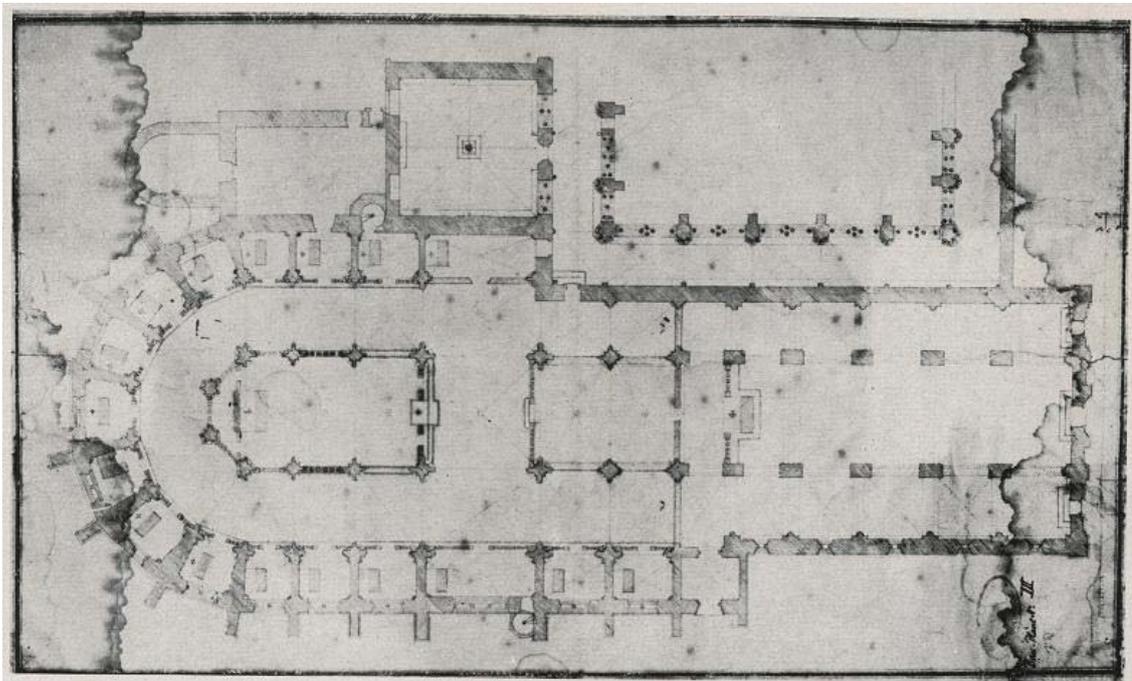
Zwettl, Stiftskirche: Grundriss der Kirche vor dem Umbau 1722, mit dem romanischen Langhaus und der Sakristei von 1643.
